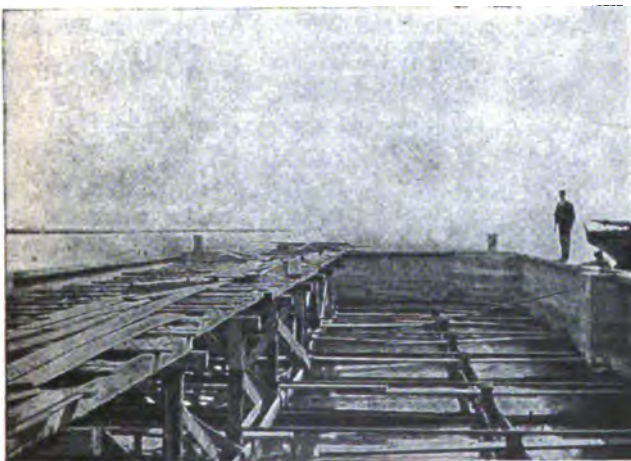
Landungsanlage in Aalborg, Inneres der fertigen, unverfüllten Anlage.
